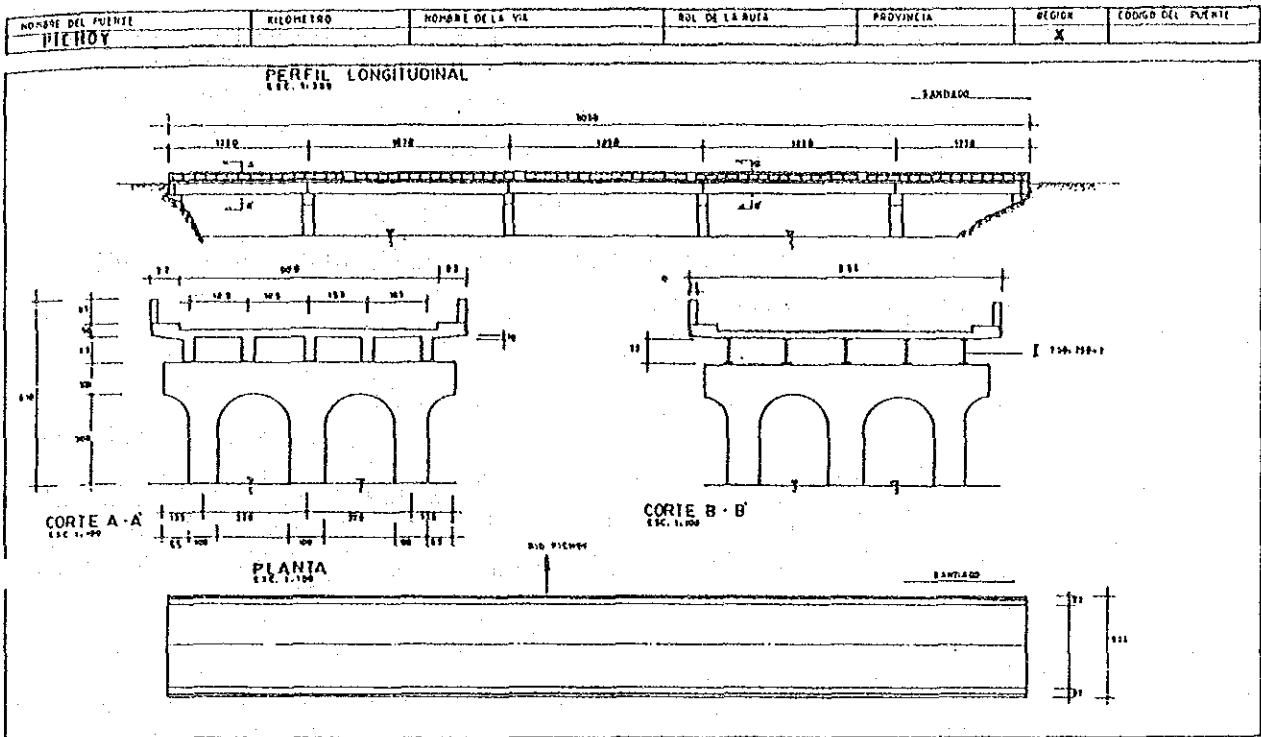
PLANO GENERAL DEL PUENTE PICHOY
